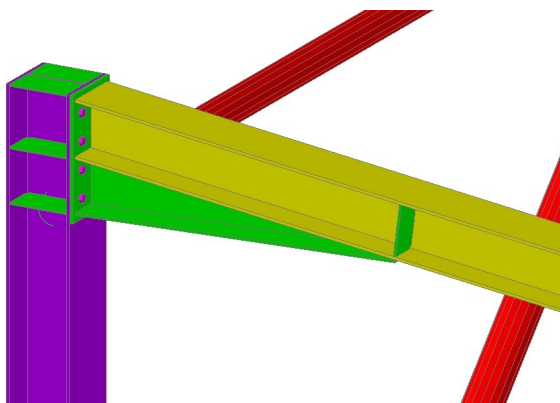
Ligação entre pilar e travessa do pórtico principal
